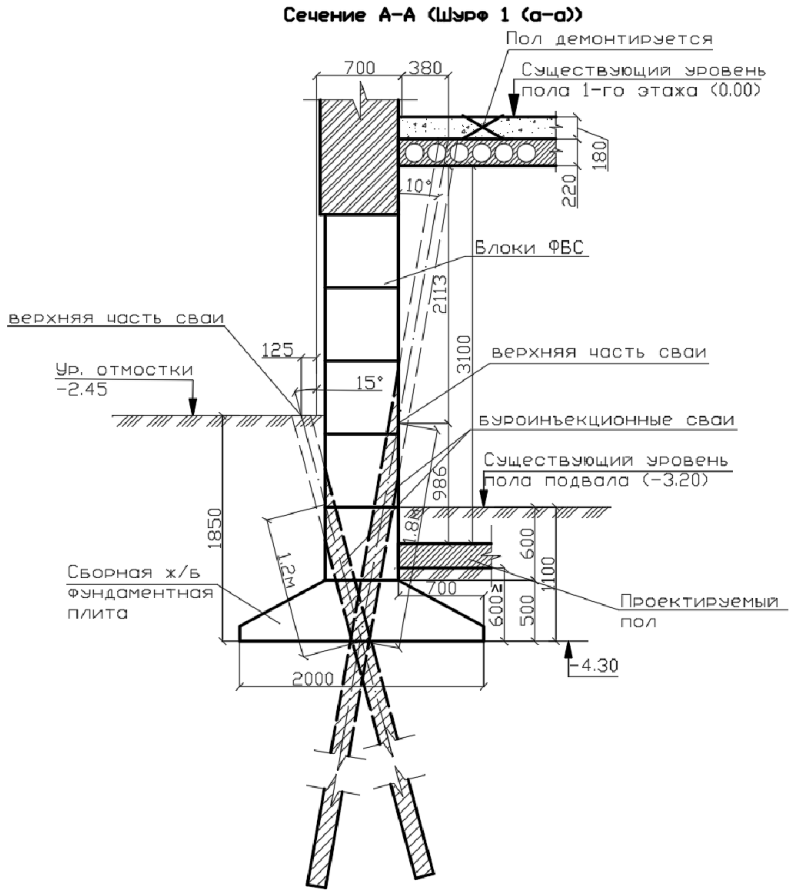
Поперечное сечение А-А усиленного основания фундамента
